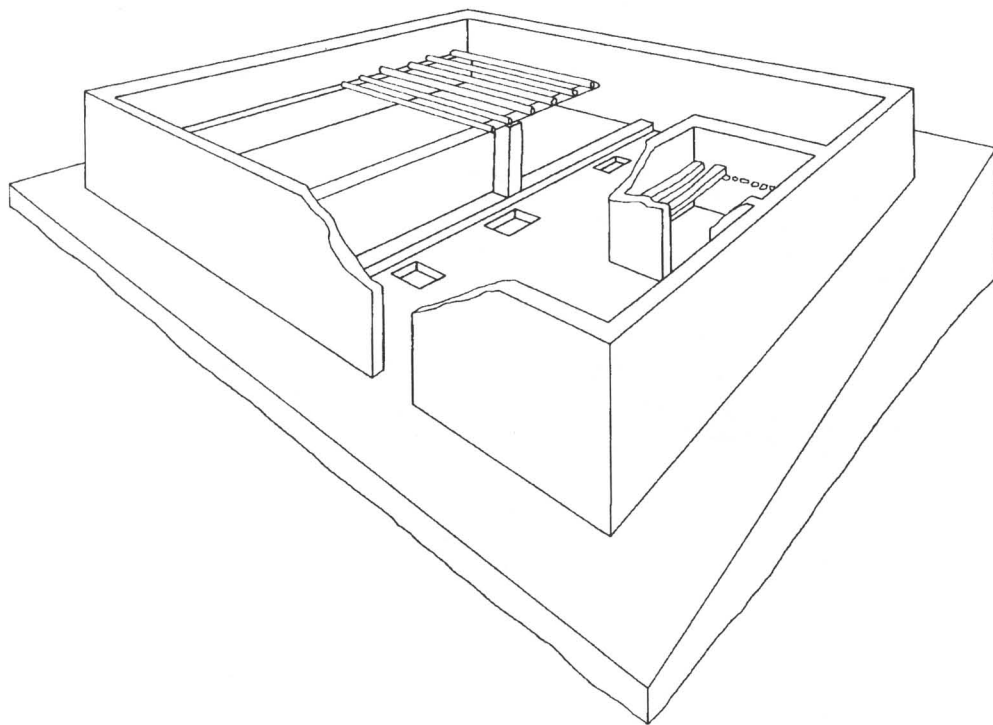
Dibujo reconstructivo del mausoleo de Cerro Amaru mostrando la planta principal con las entradas a las cámaras subterráneas y un desván construido de vigas de madera en la parte oeste. La cámara pequeña en el lado este también tuvo dos niveles, con un desván soportado por vigas de piedra.
